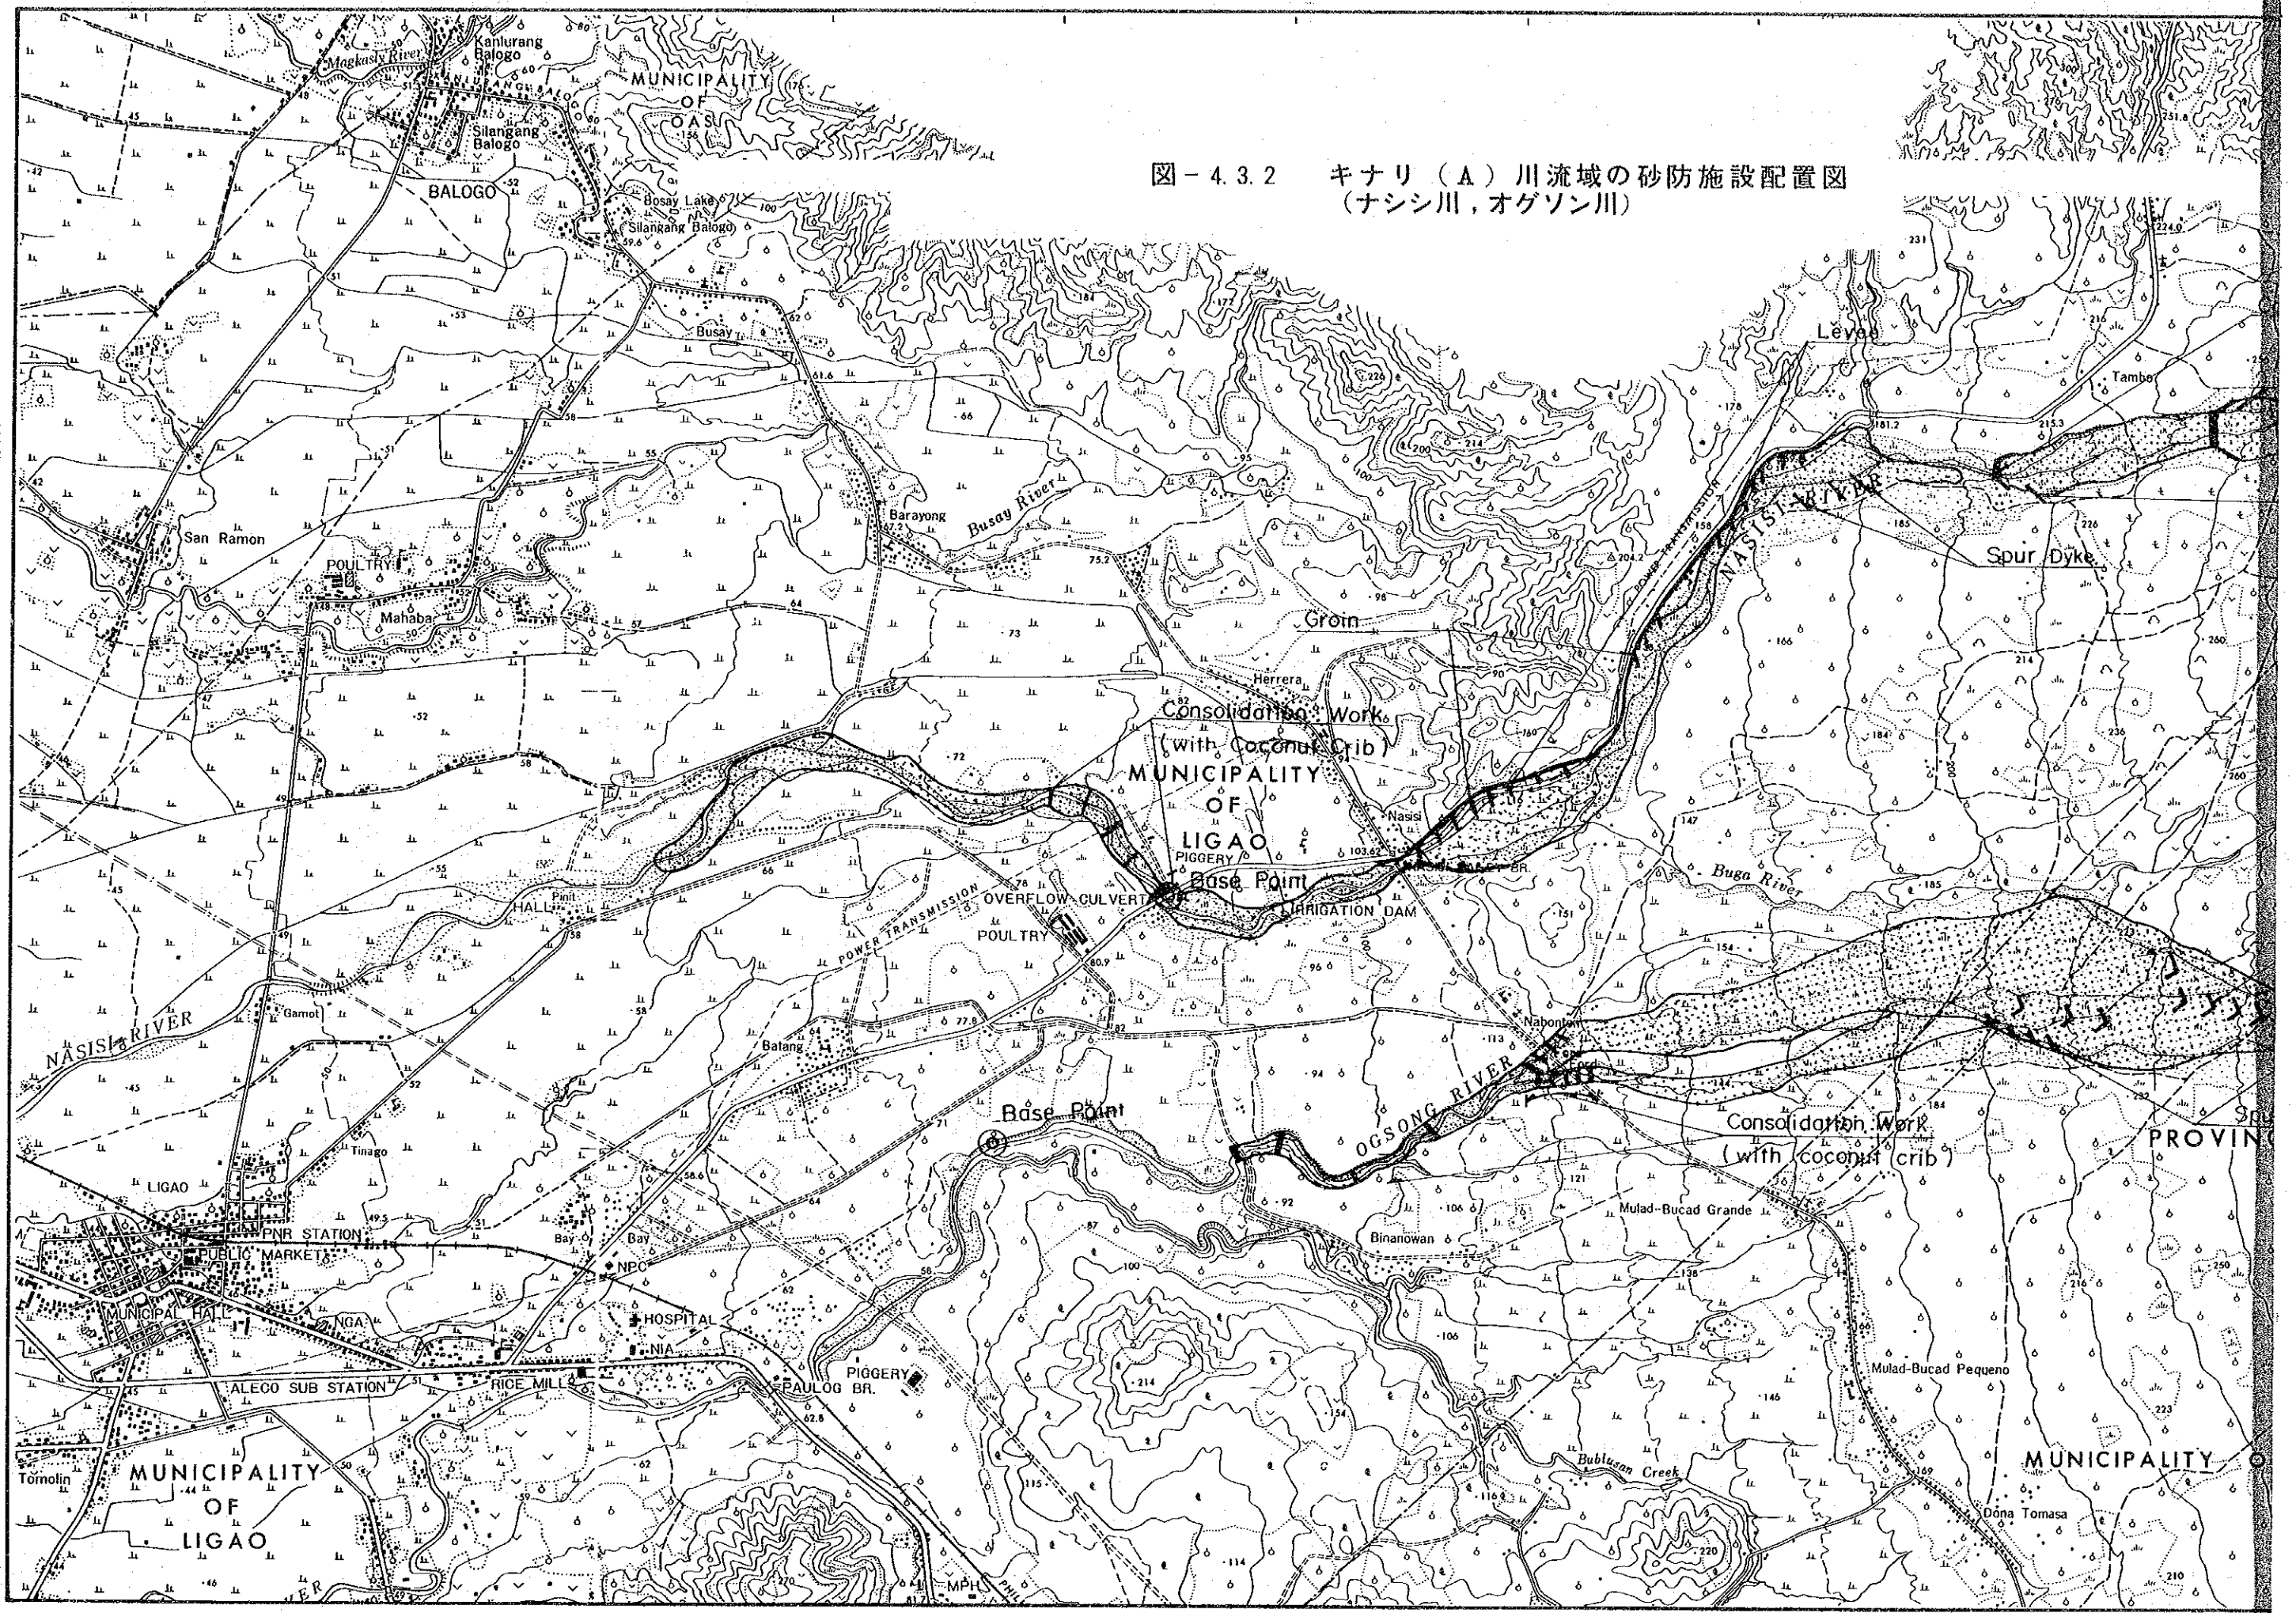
キナリ(A)川流域の砂防施設配置図
